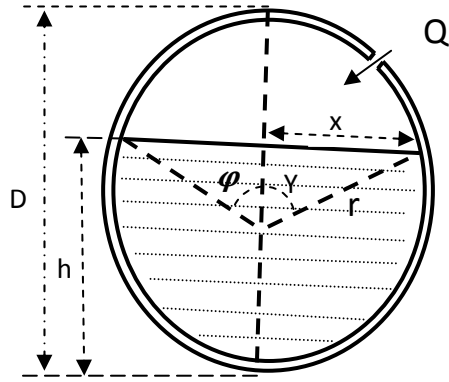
Section mouillée dans un collecteur d'assainissement.
